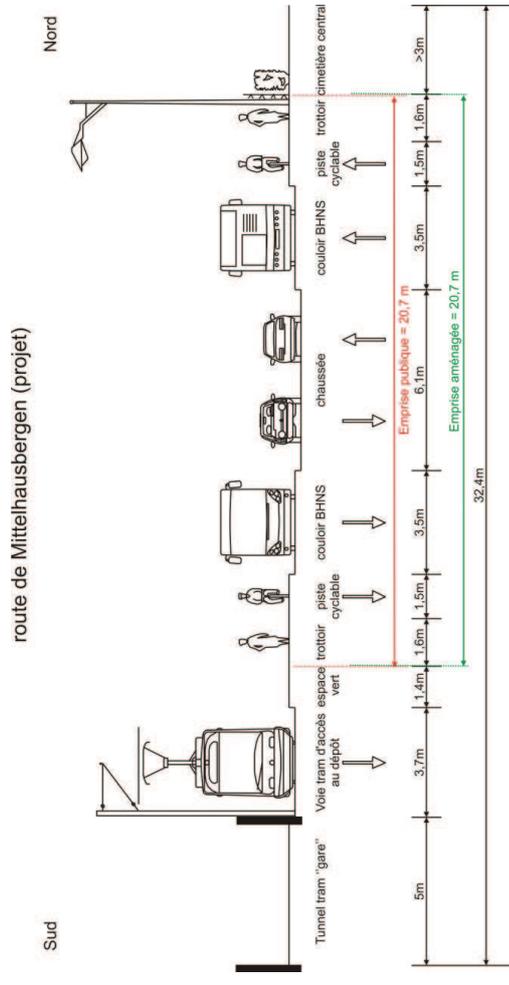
Situation projetée (coupe 34) route de *Mittelhausbergen
